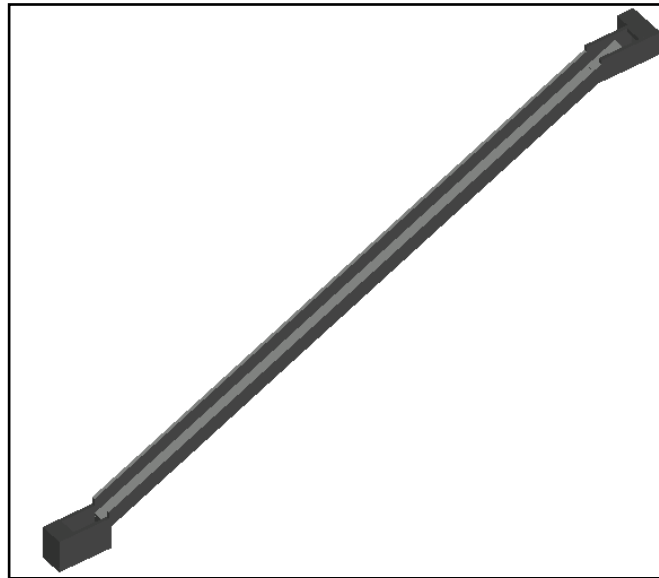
Estructura de hormigón armado del ascensor inclinado.
